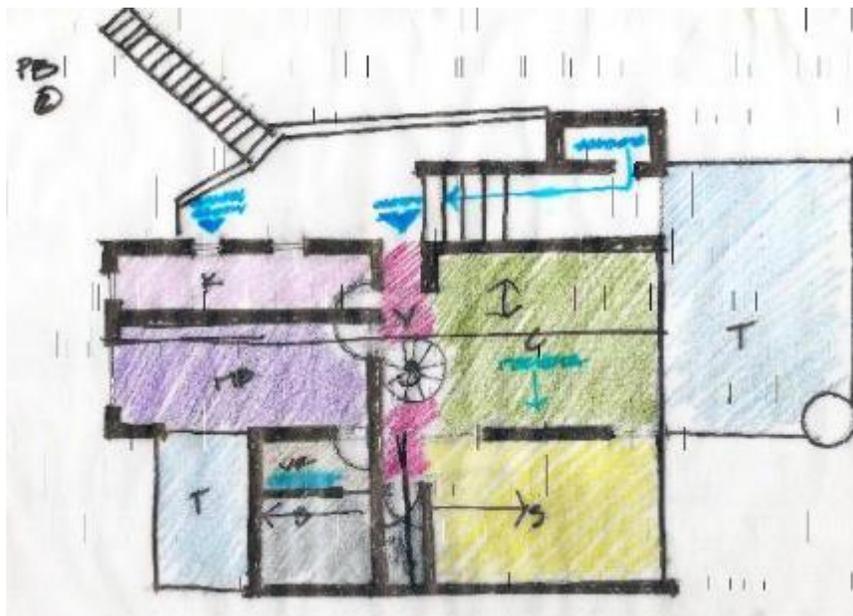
Distribución de áreas en Planta Baja. Opción 2
